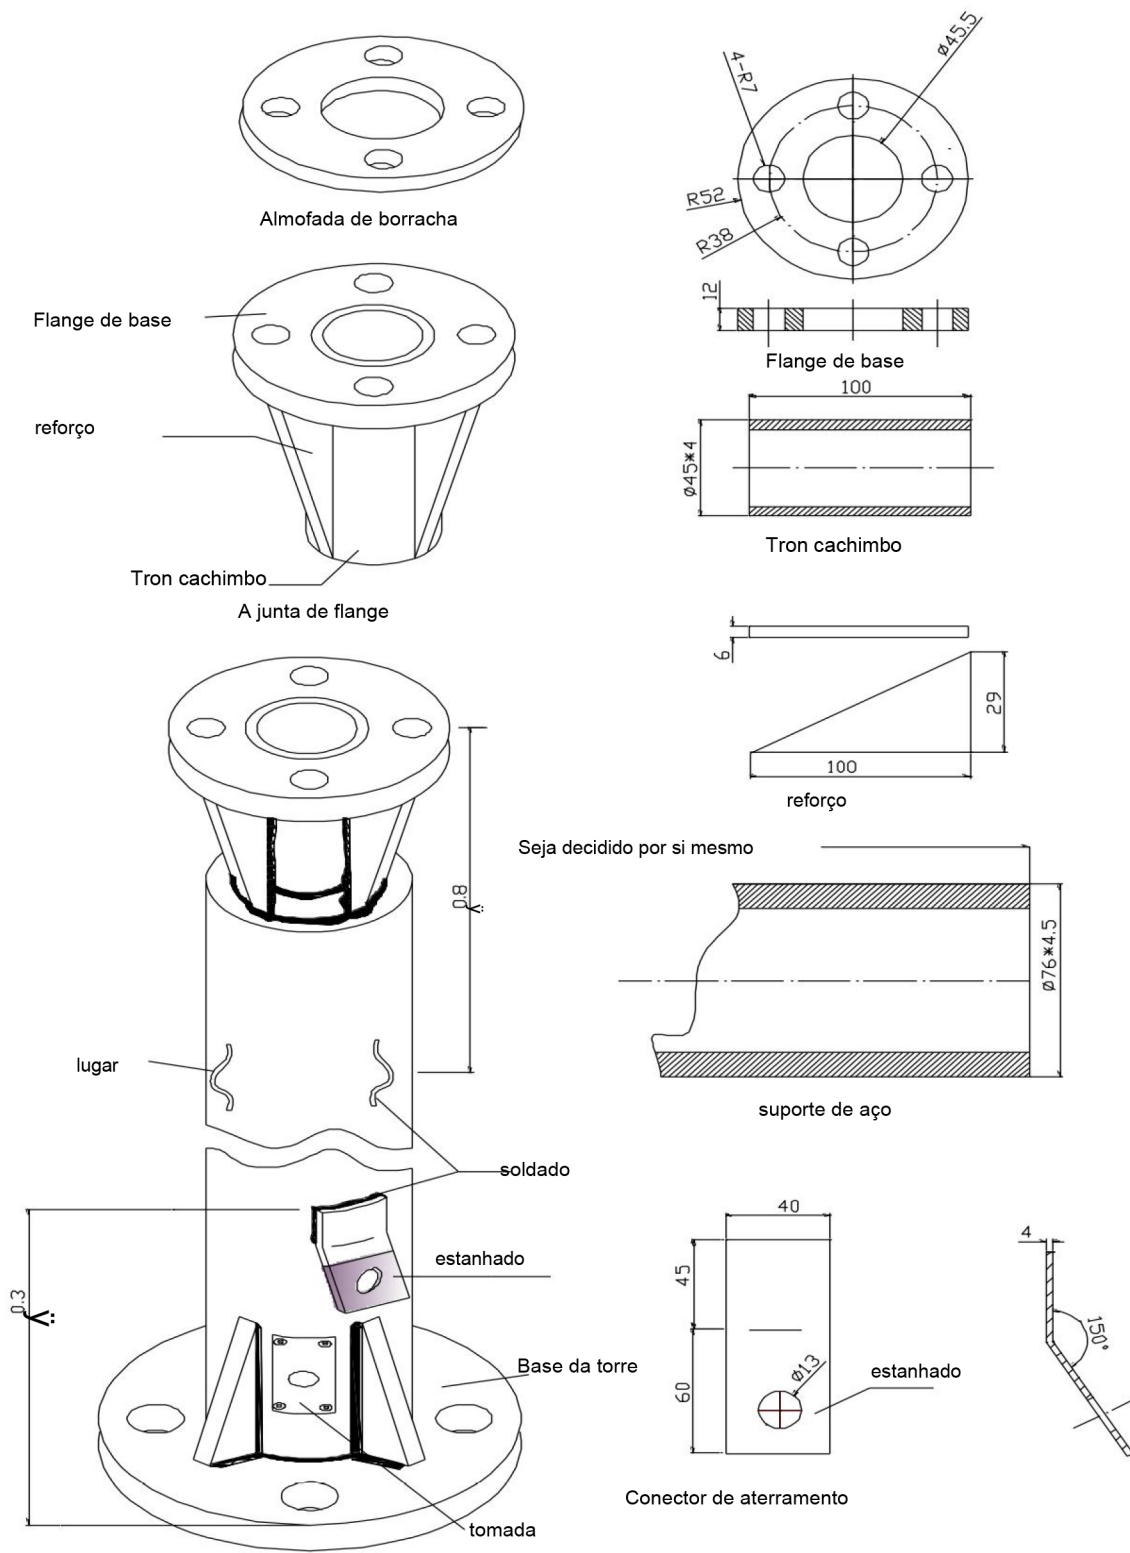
Acoplamento da placa da turbina eólica à torre superior
